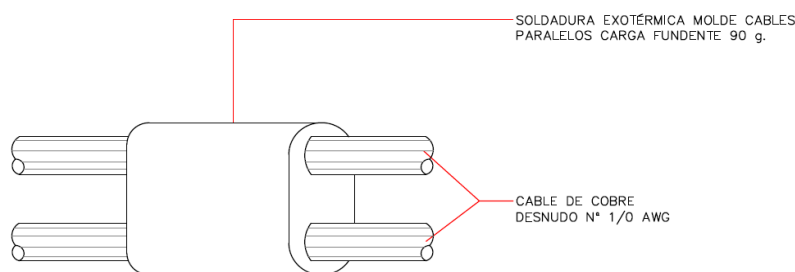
Conexión con soldadura exotérmica de cables en paralelo
